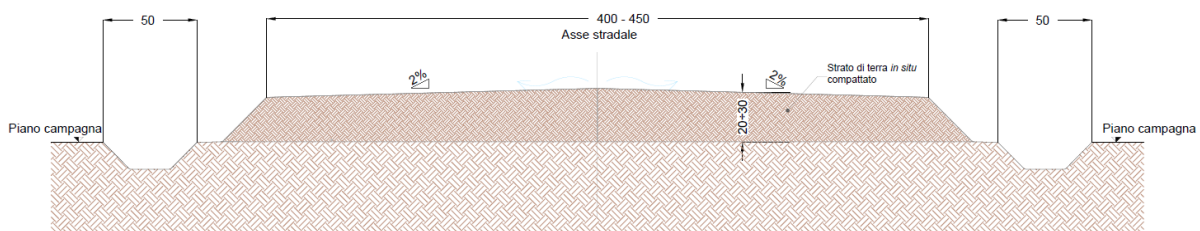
Sezione tipo di strada bianca in terra battuta, misure in cm
